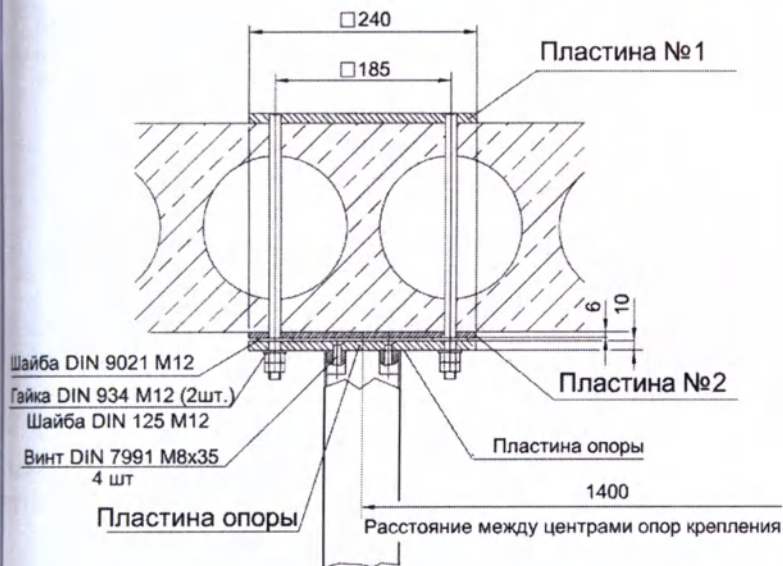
Крепление опор крепления консоли к потолочному перекрытию
